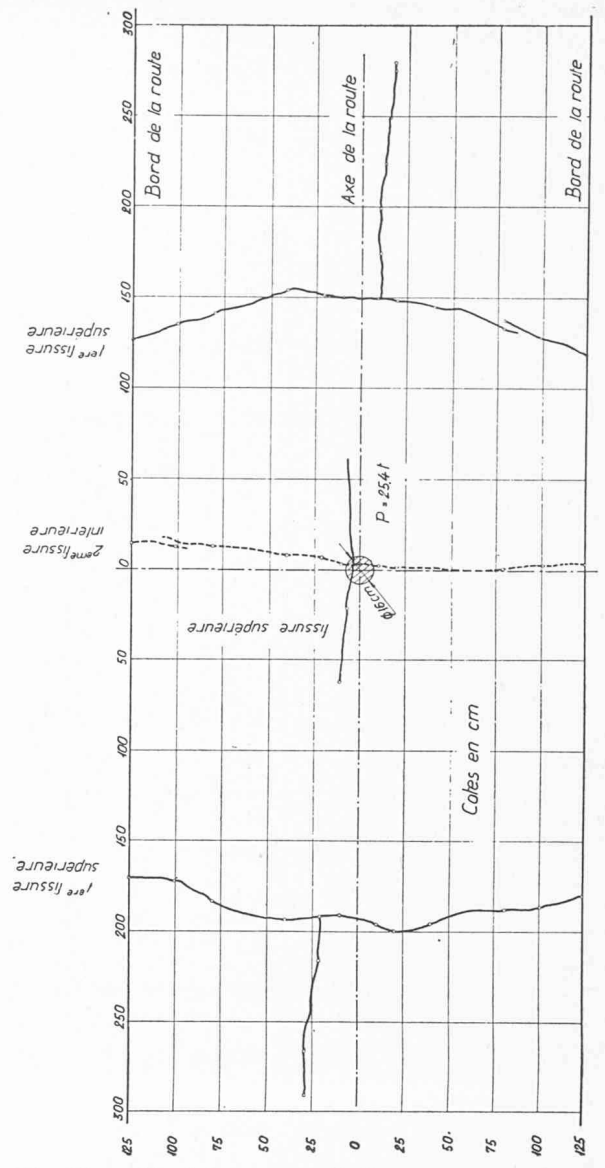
Essai à outrance. Dalle non précontrainte. Fissures observées au moment de la rupture.
